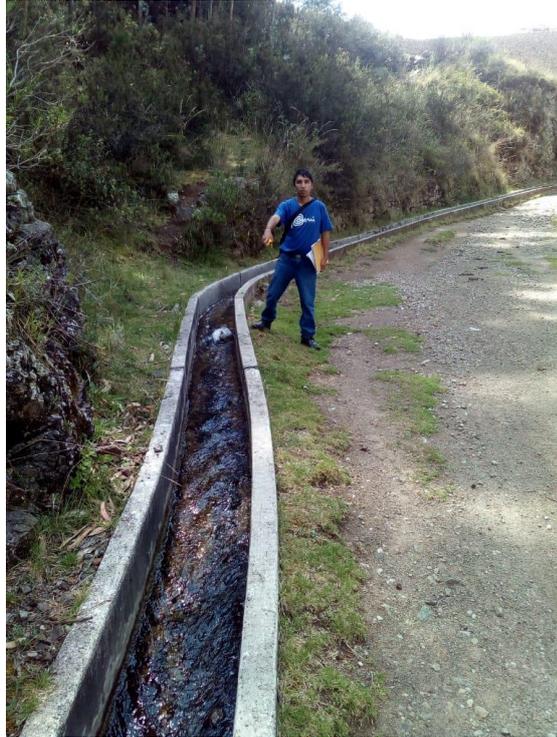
IDENTIFICACIÓN DE UNA GRIETA EN EL CANAL
